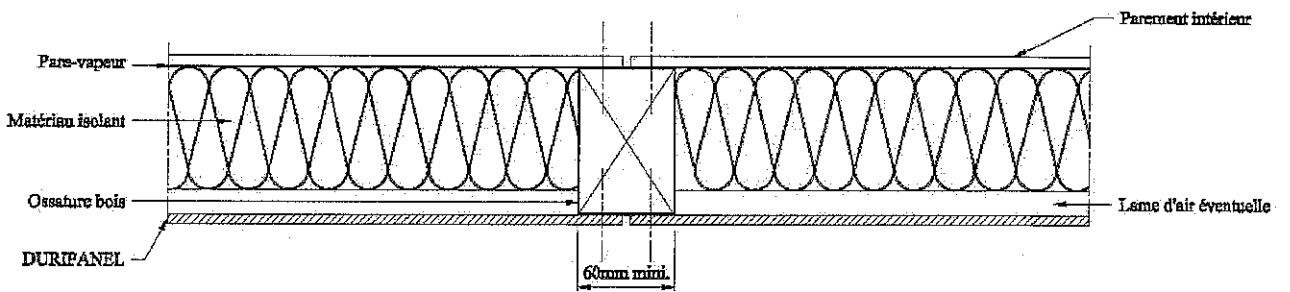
Coupe sur montant d'ossature avec joint vertical
